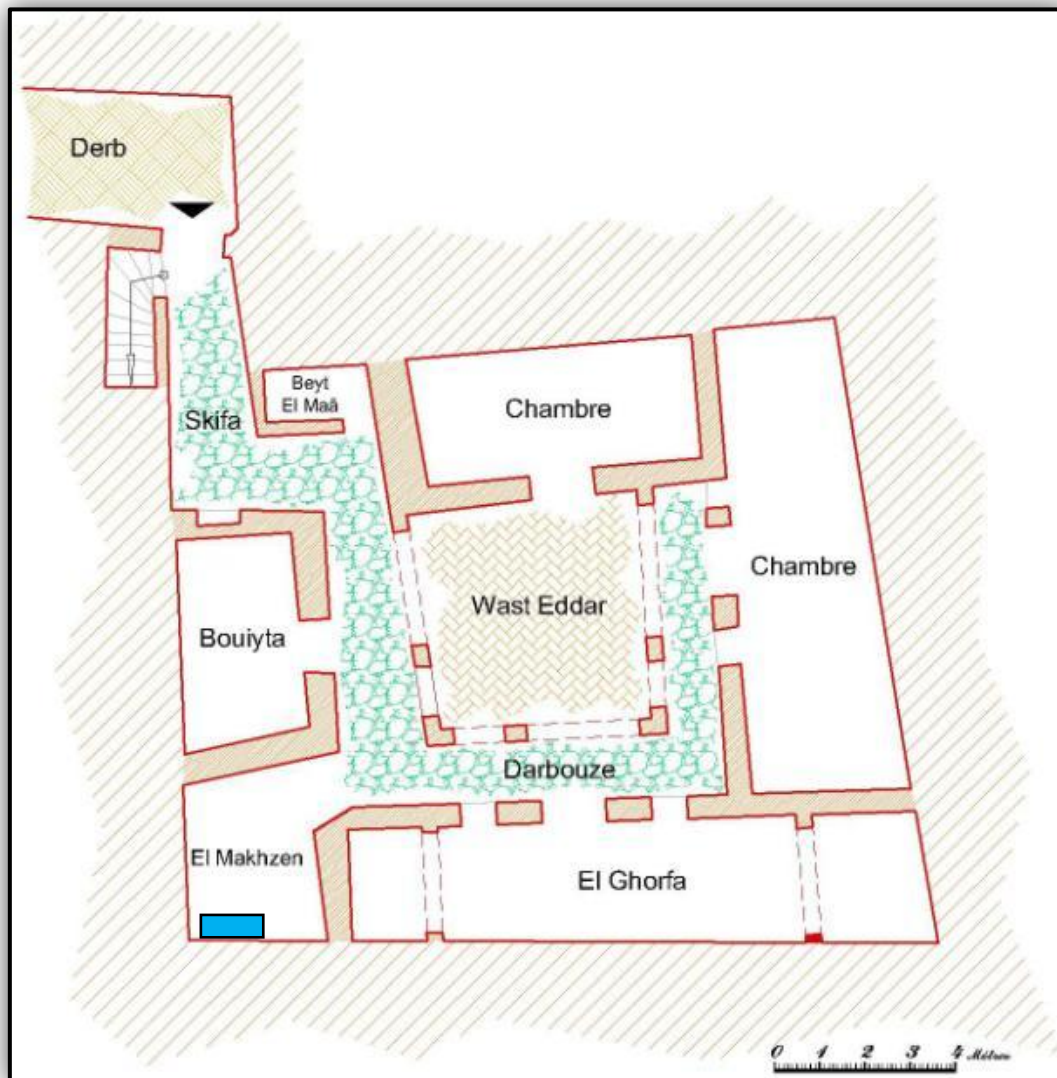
Plan du rez de chaussée, maison n°12, *Dar Ben Tabet*.
